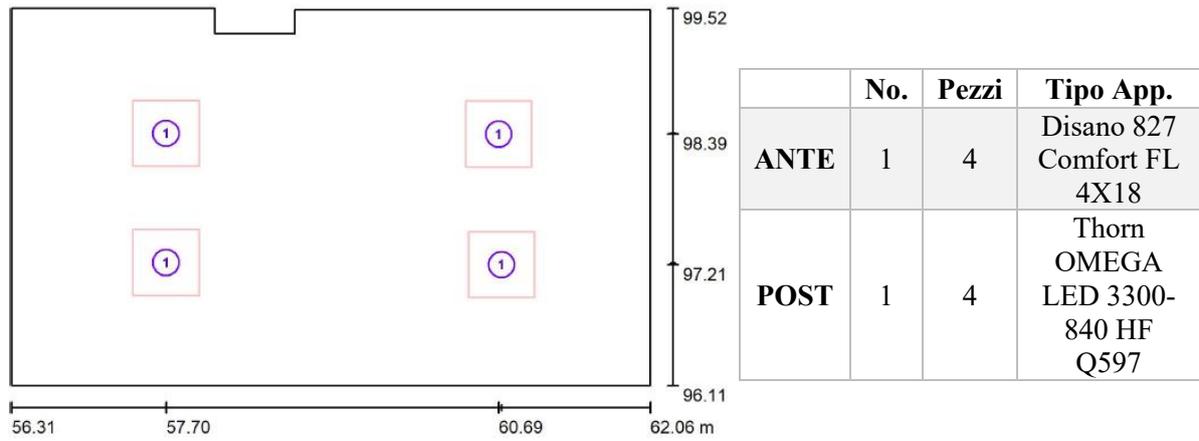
Disposizione in pianta degli apparecchi di illuminazione.
